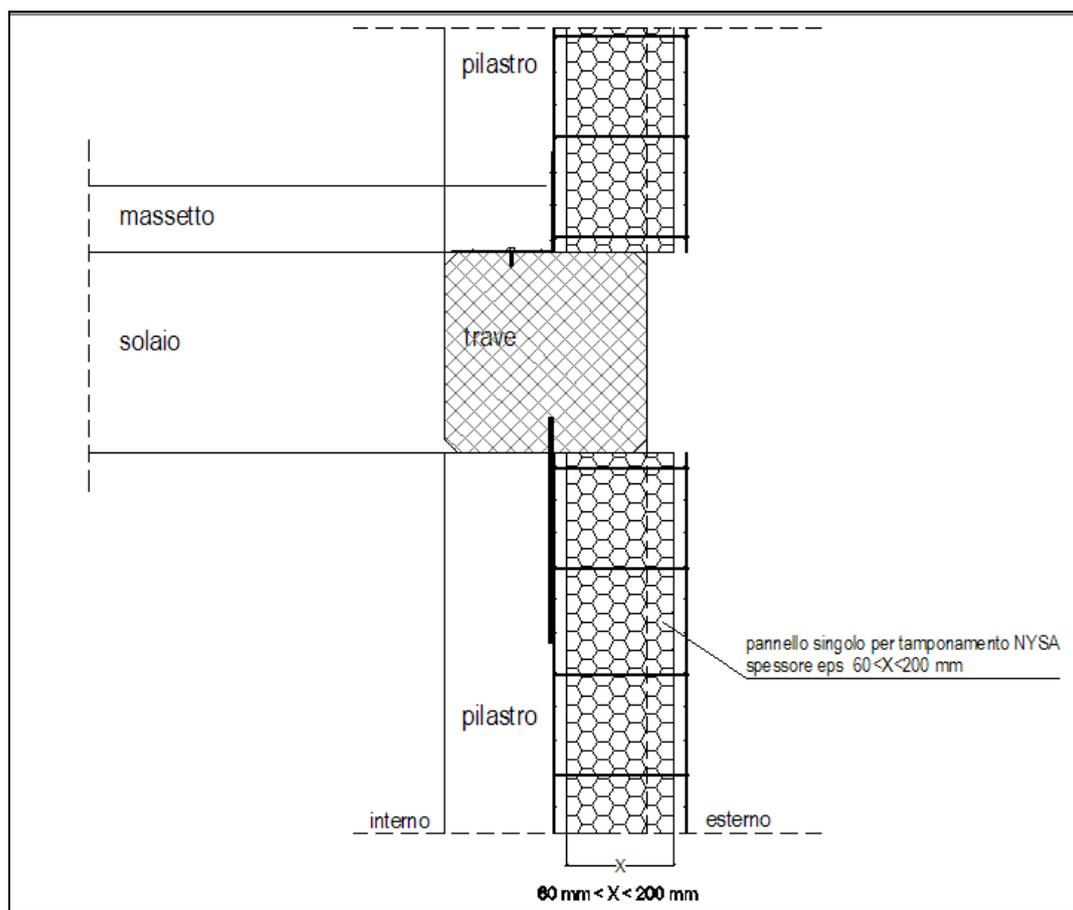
Fase 2 - -Casi A e C: sezione verticale del collegamento.
